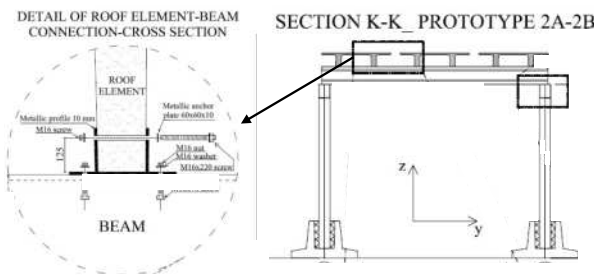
Dettagli del collegamento tegolo-trave in sezione y-z
